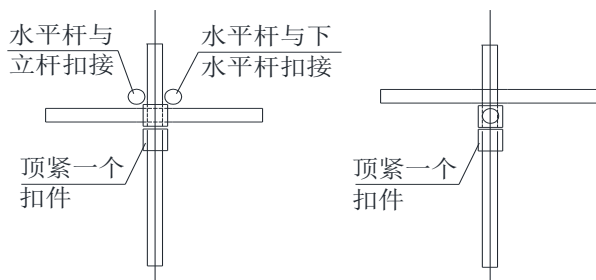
构造三节点（满堂脚手架施工层受力节点）简图
